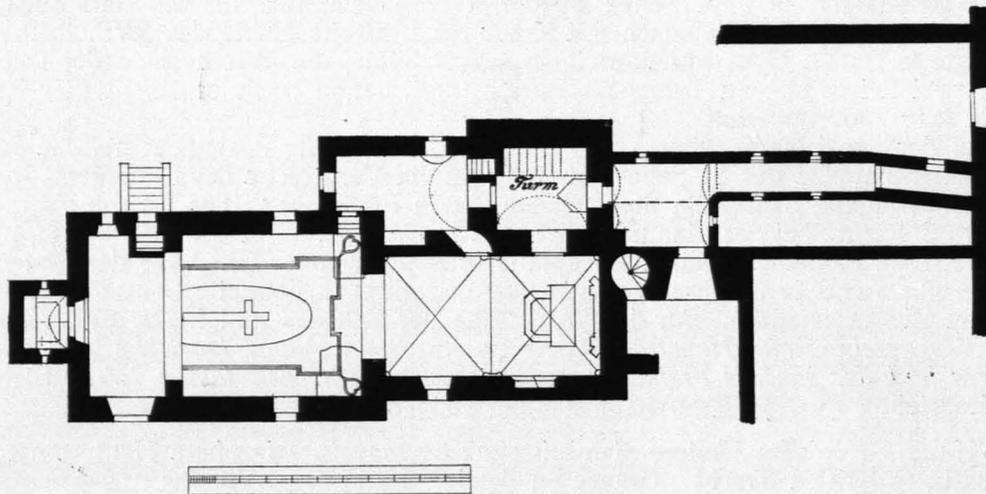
Maigen, Pfarrkirche, Grundriß 1 : 300 (S. 96)
